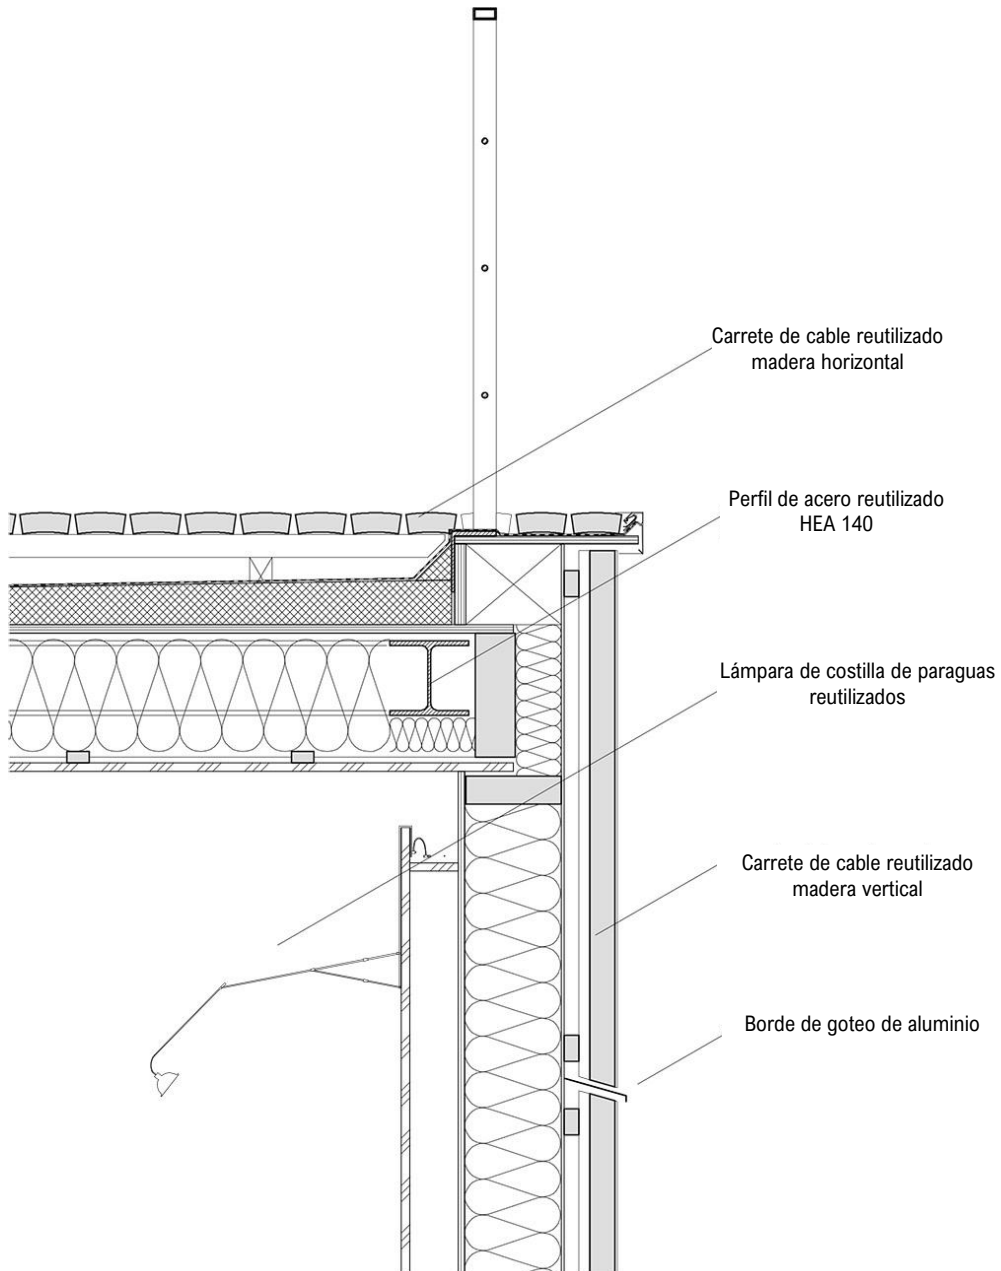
Sección constructiva (Jan Jongert et al,2016).
